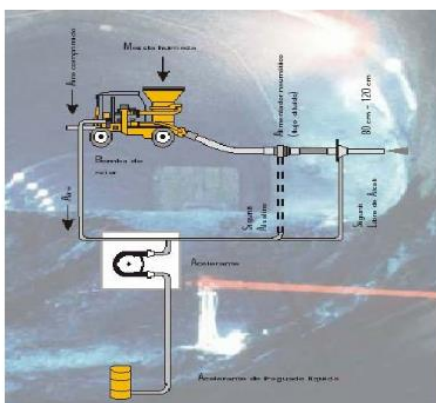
Aplicación de concreto lanzado por vía seca
